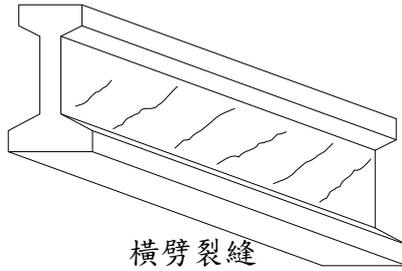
混凝土 T 型梁裂縫示意圖
